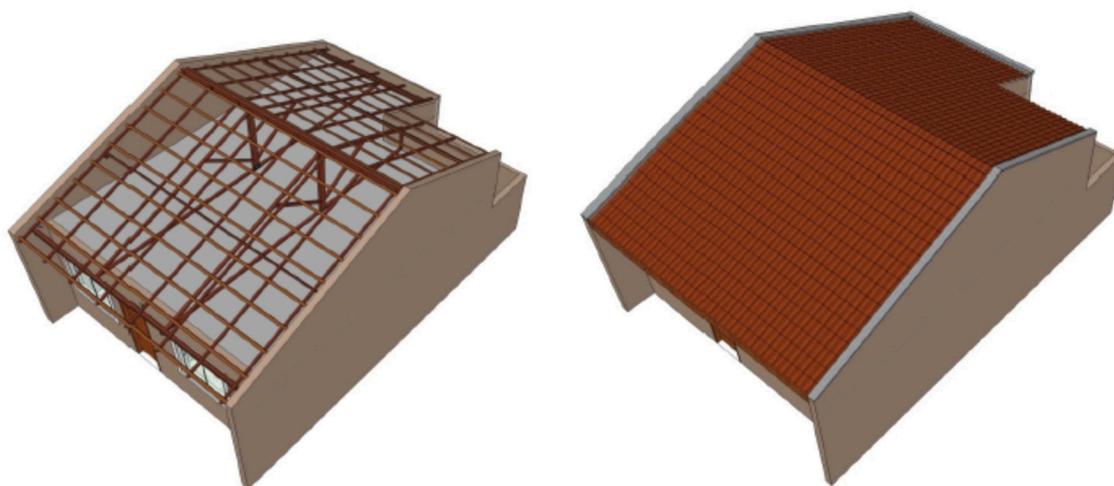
Estrutura do telhado em madeira com cobertura em telha cerâmica tipo romana.
